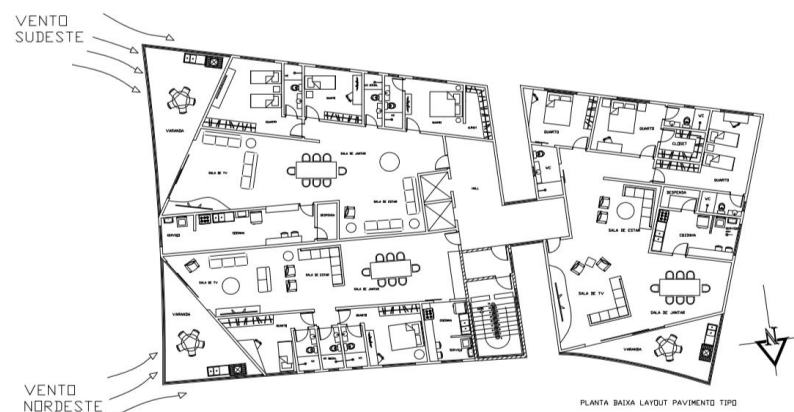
Planta baixa pavimento tipo. Fonte: elaborado pelos autores.
